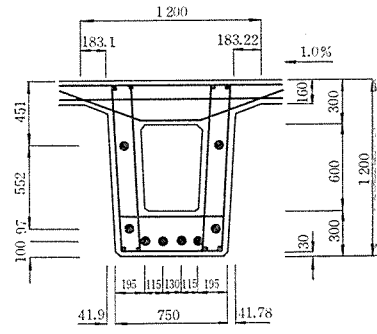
MB 中央横桁ケーブル配線図 (一部抜粋)
